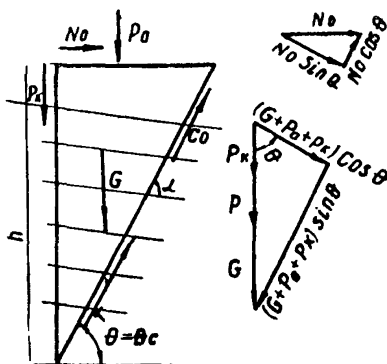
Расчетная схема крепления стен камерной выработки анкерами
